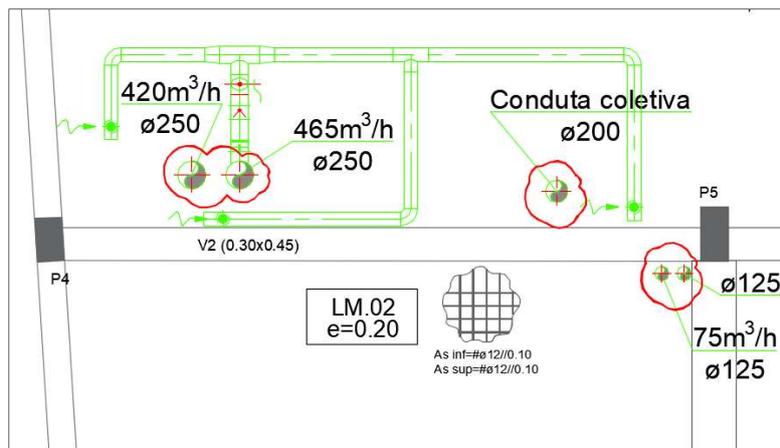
Sobreposição entre projetos de Estrutura e Avac
